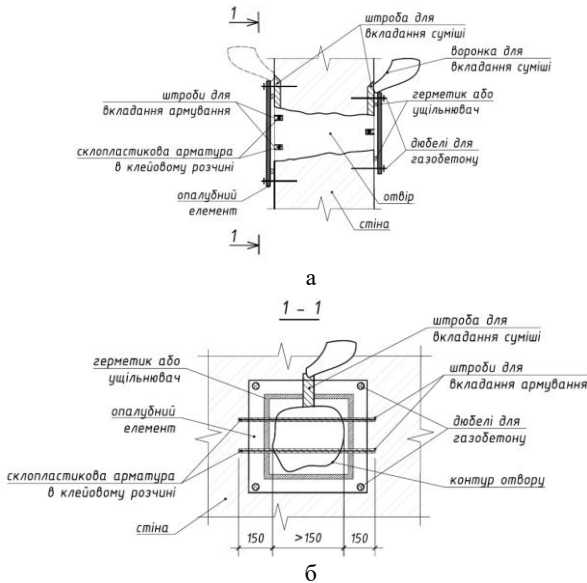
Схема відновлення конструкції з ніздрюватого бетону: а) поперечний переріз конструкції; б) вид 1-1
